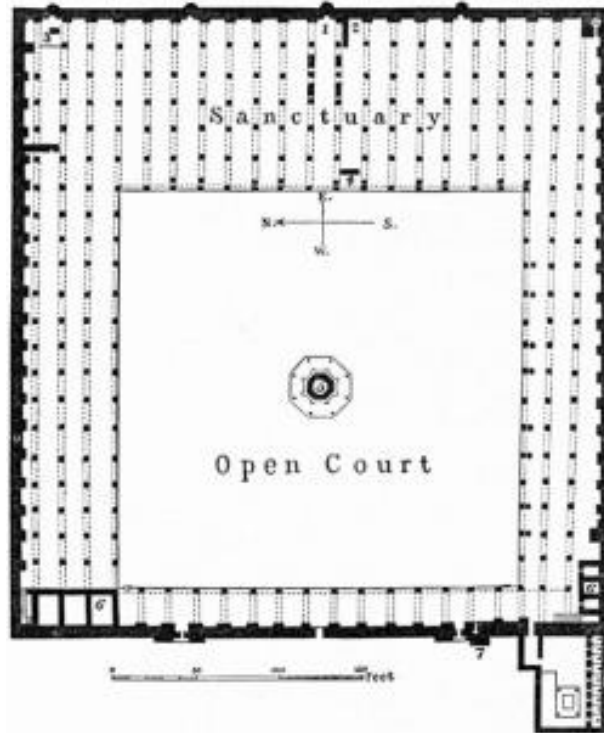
Planta de la Mezquita de `Amr. Plano de 1883, El Cairo, siglo VII.
